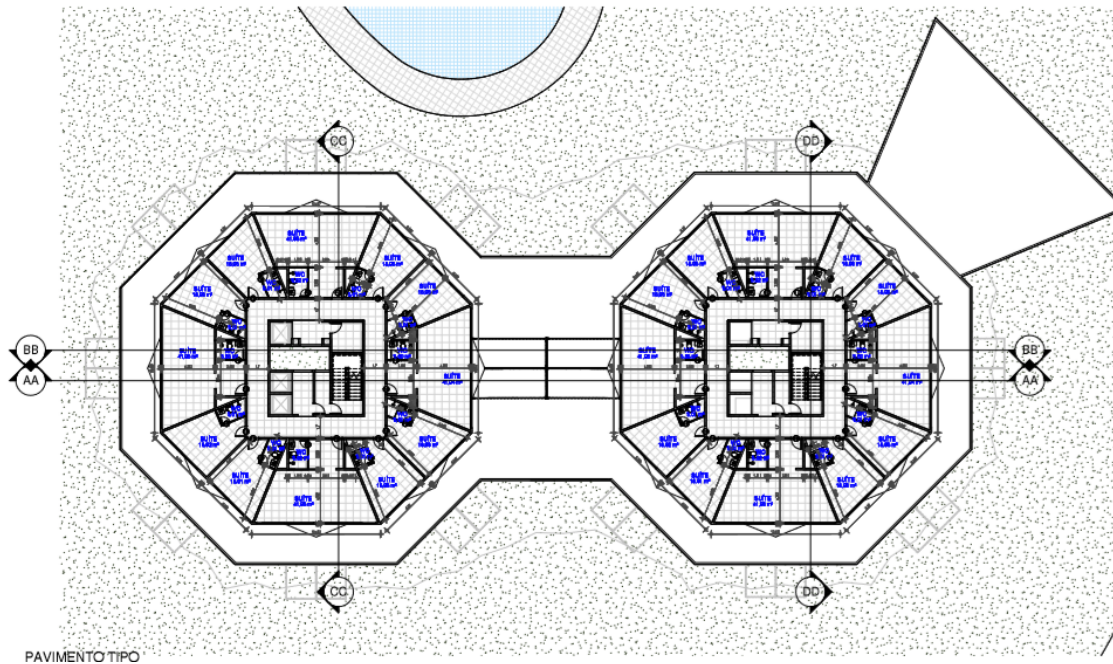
Planta baixa do pavimento tipo do Hotel Fractal.
